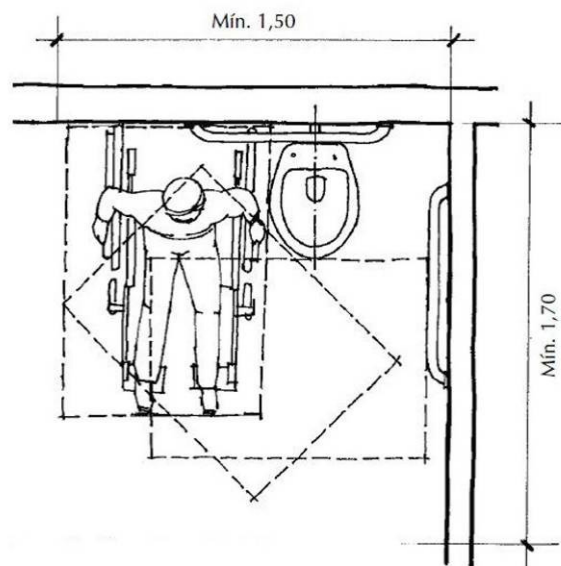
área de transferência para a bacia sanitária (SMPED, 2008).
